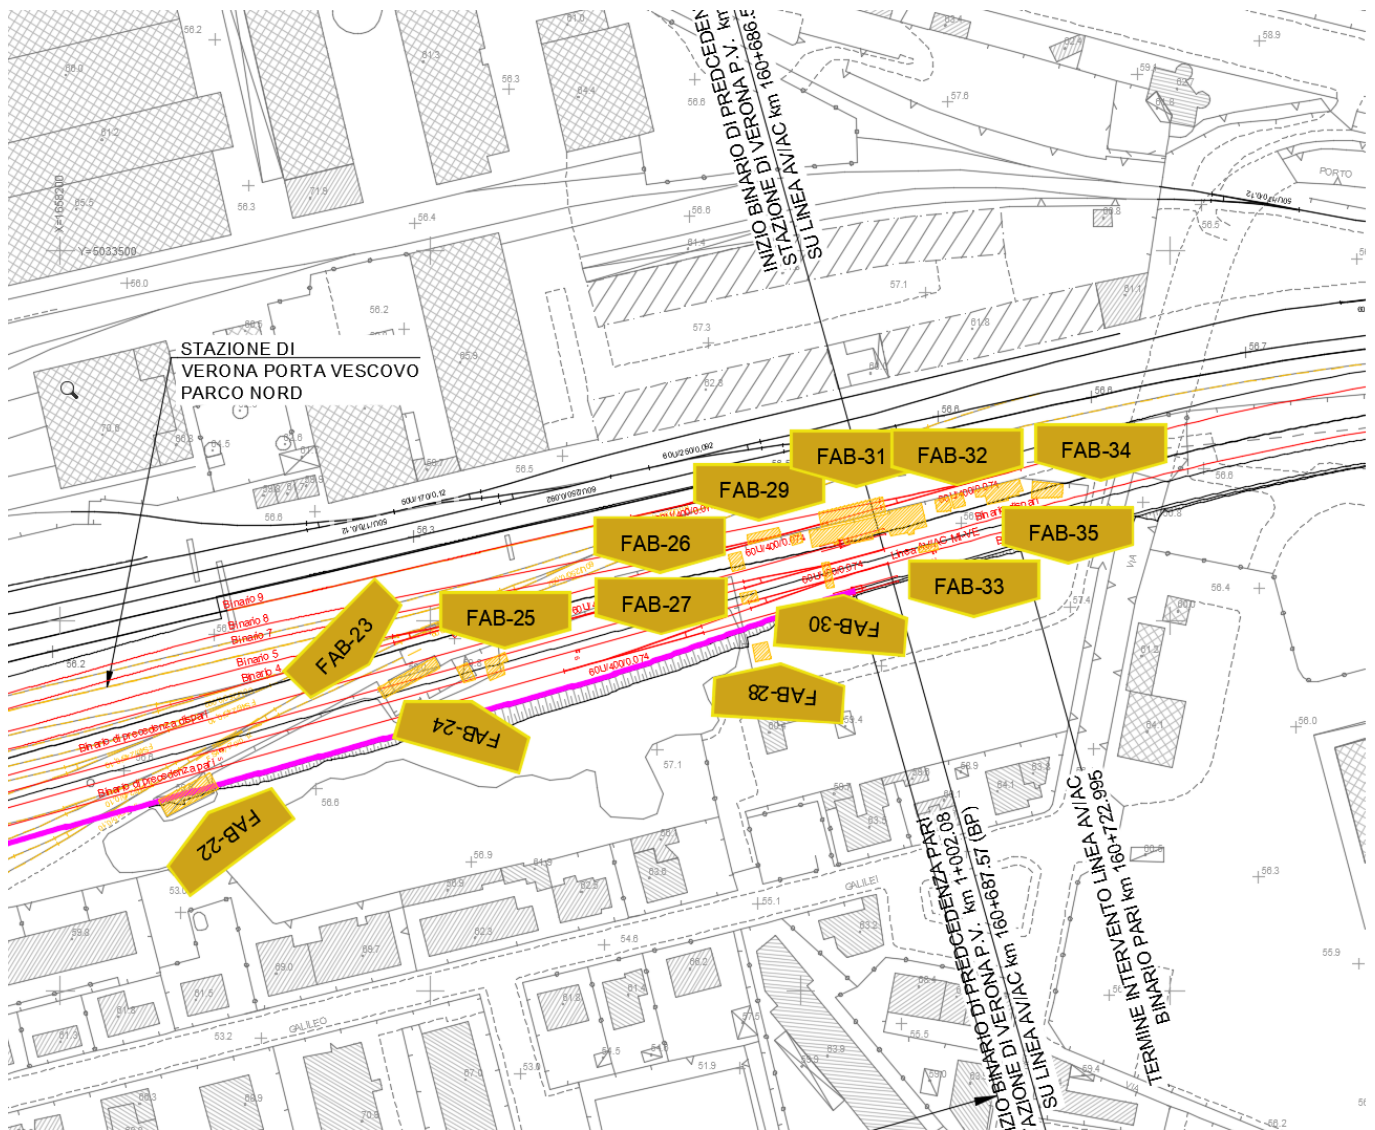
Stralcio planimetrico zona Parco Nord Stazione Porta Vescovo
